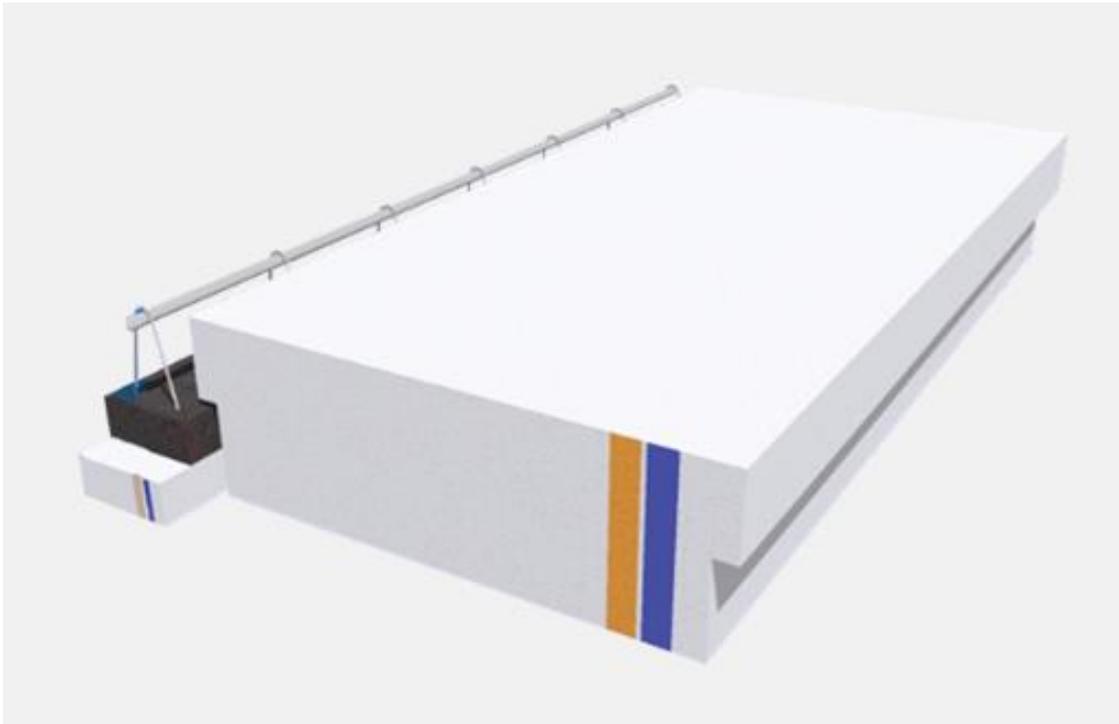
Casetón peraltado con fajilla de poliestireno bajo vigueta de concreto
